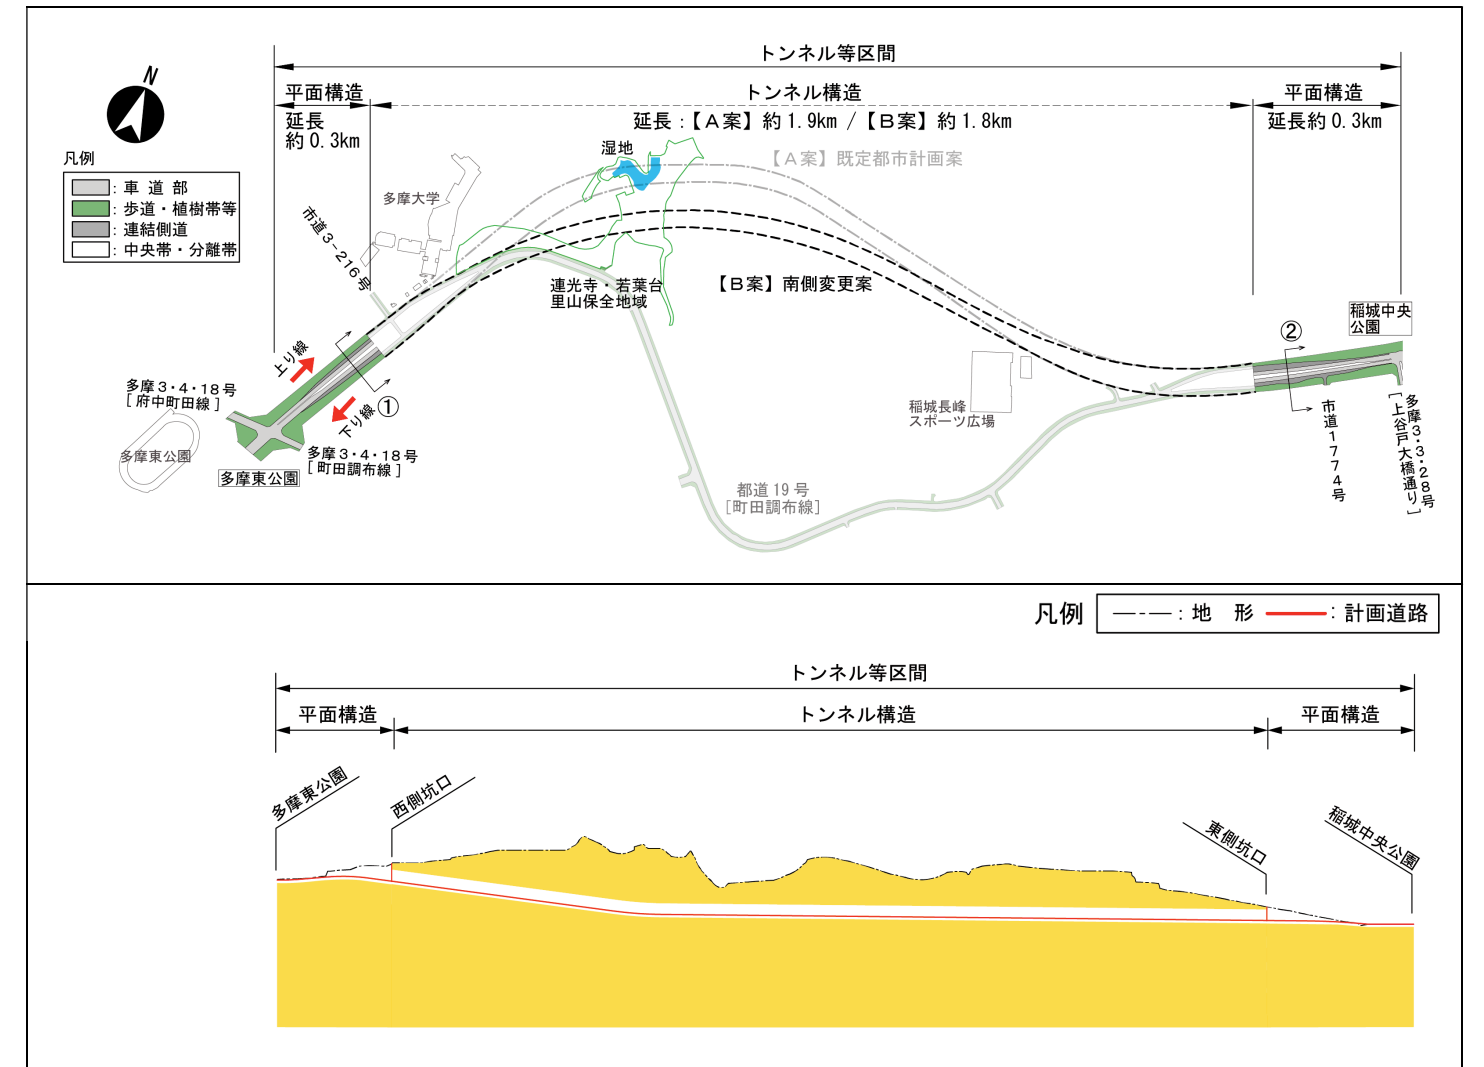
(2) 【B案】南側変更案の道路平面図及び縦断面図
